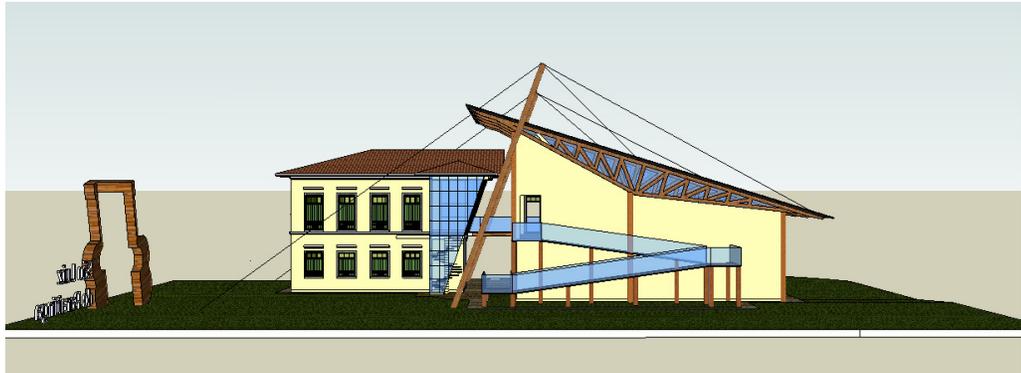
Elevação Posterior, ilustrando as rampas de acesso
